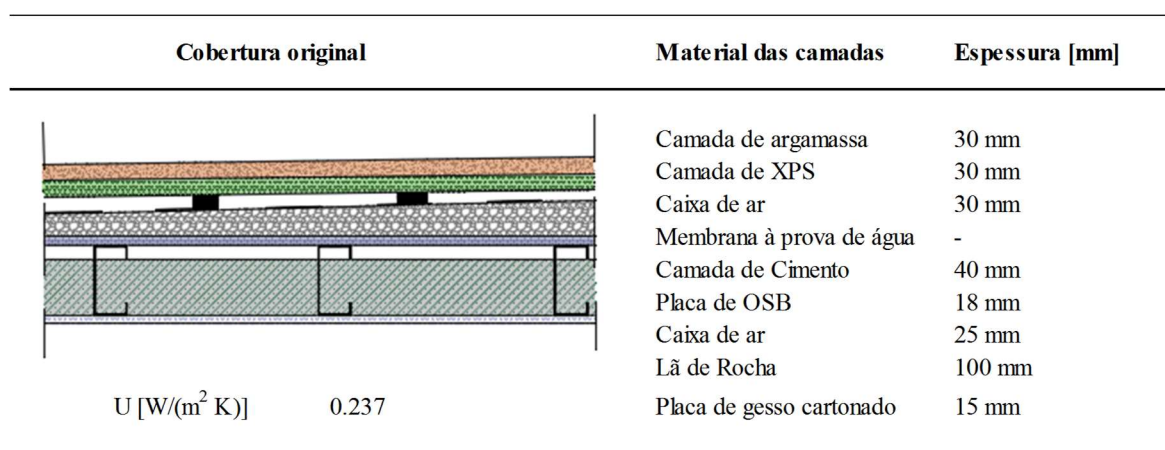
Pormenor construtivo e propriedades da cobertura do piso 1
